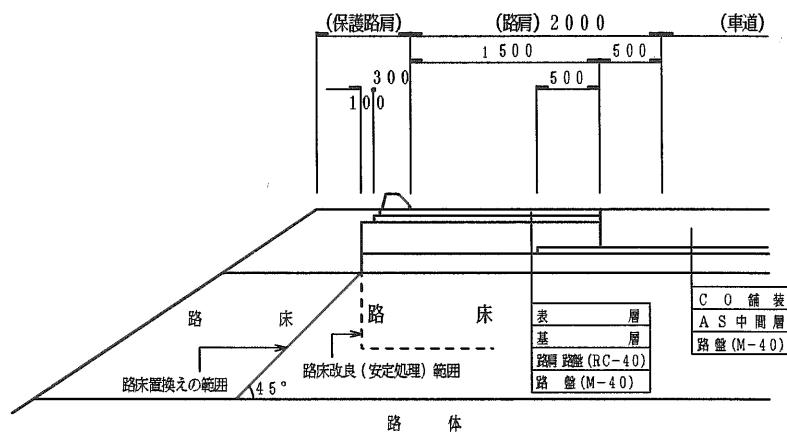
46 一般部（コンクリート舗装） (単位 : mm)
